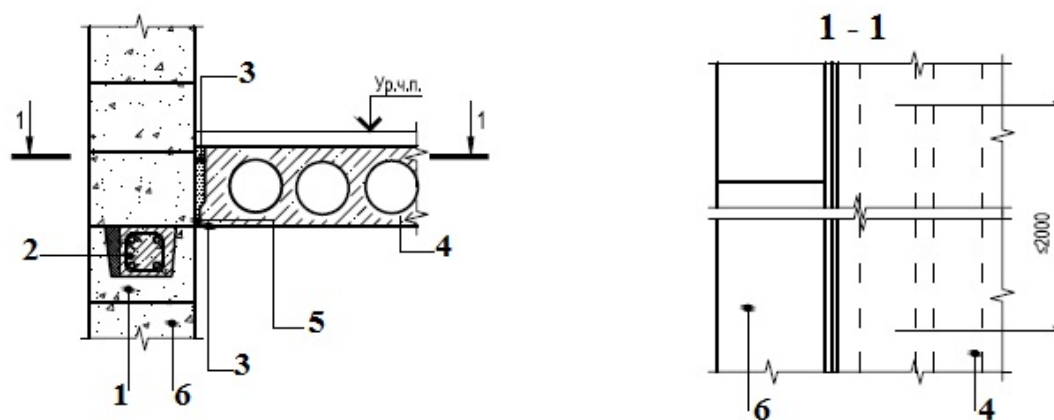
Примыкание наружной стены из газобетонных блоков к железобетонной плите перекрытия: 1 — U-образный блок; 2 — железобетонный пояс; 3 — раствор; 4 — железобетонная плита перекрытия; 5 — поризол; 6 — блоки YTONG
